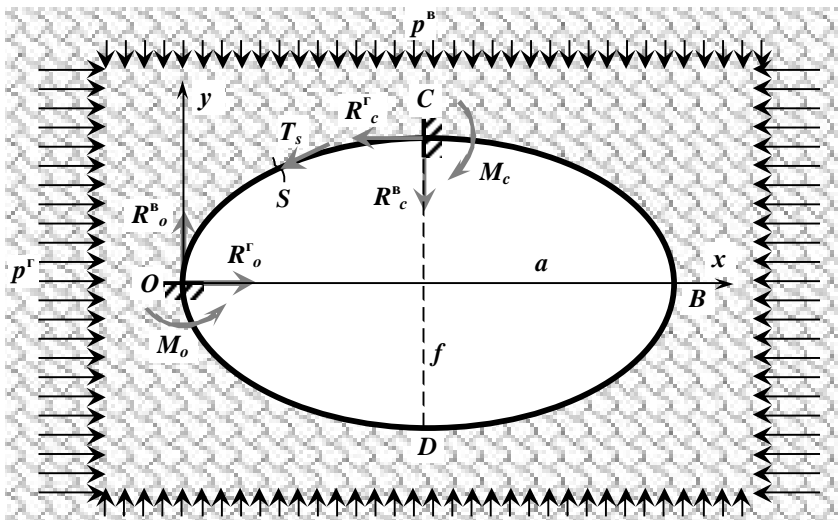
Схема к расчету монолитной бетонной крепи, не испытывающей изгиба
